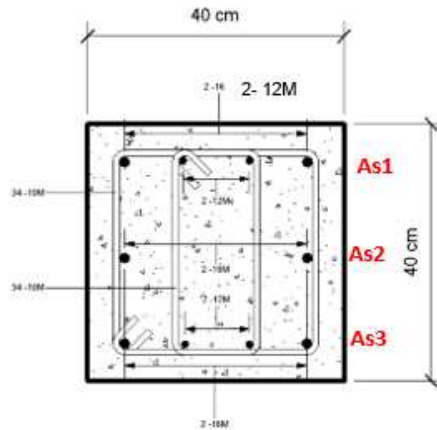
Armado de refuerzo de la columna (SMF) del sistema de 3 Pisos
